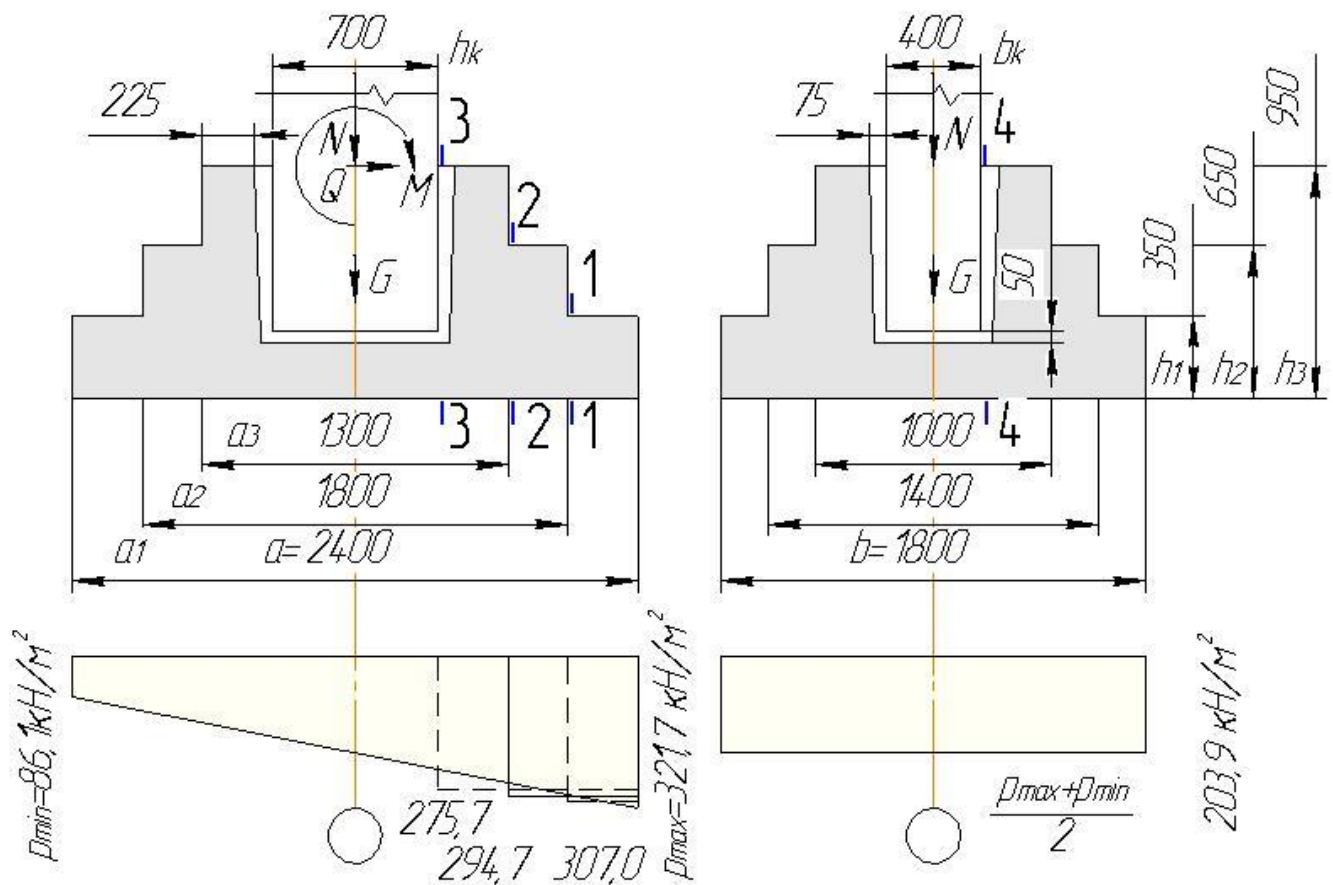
К расчету монолитного столбчатого фундамента под колонну
